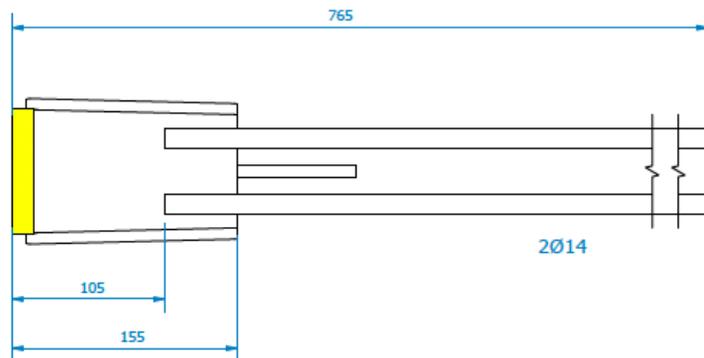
Ejemplos de uso: Caso de conexión a cimentación y empalme de pilares
